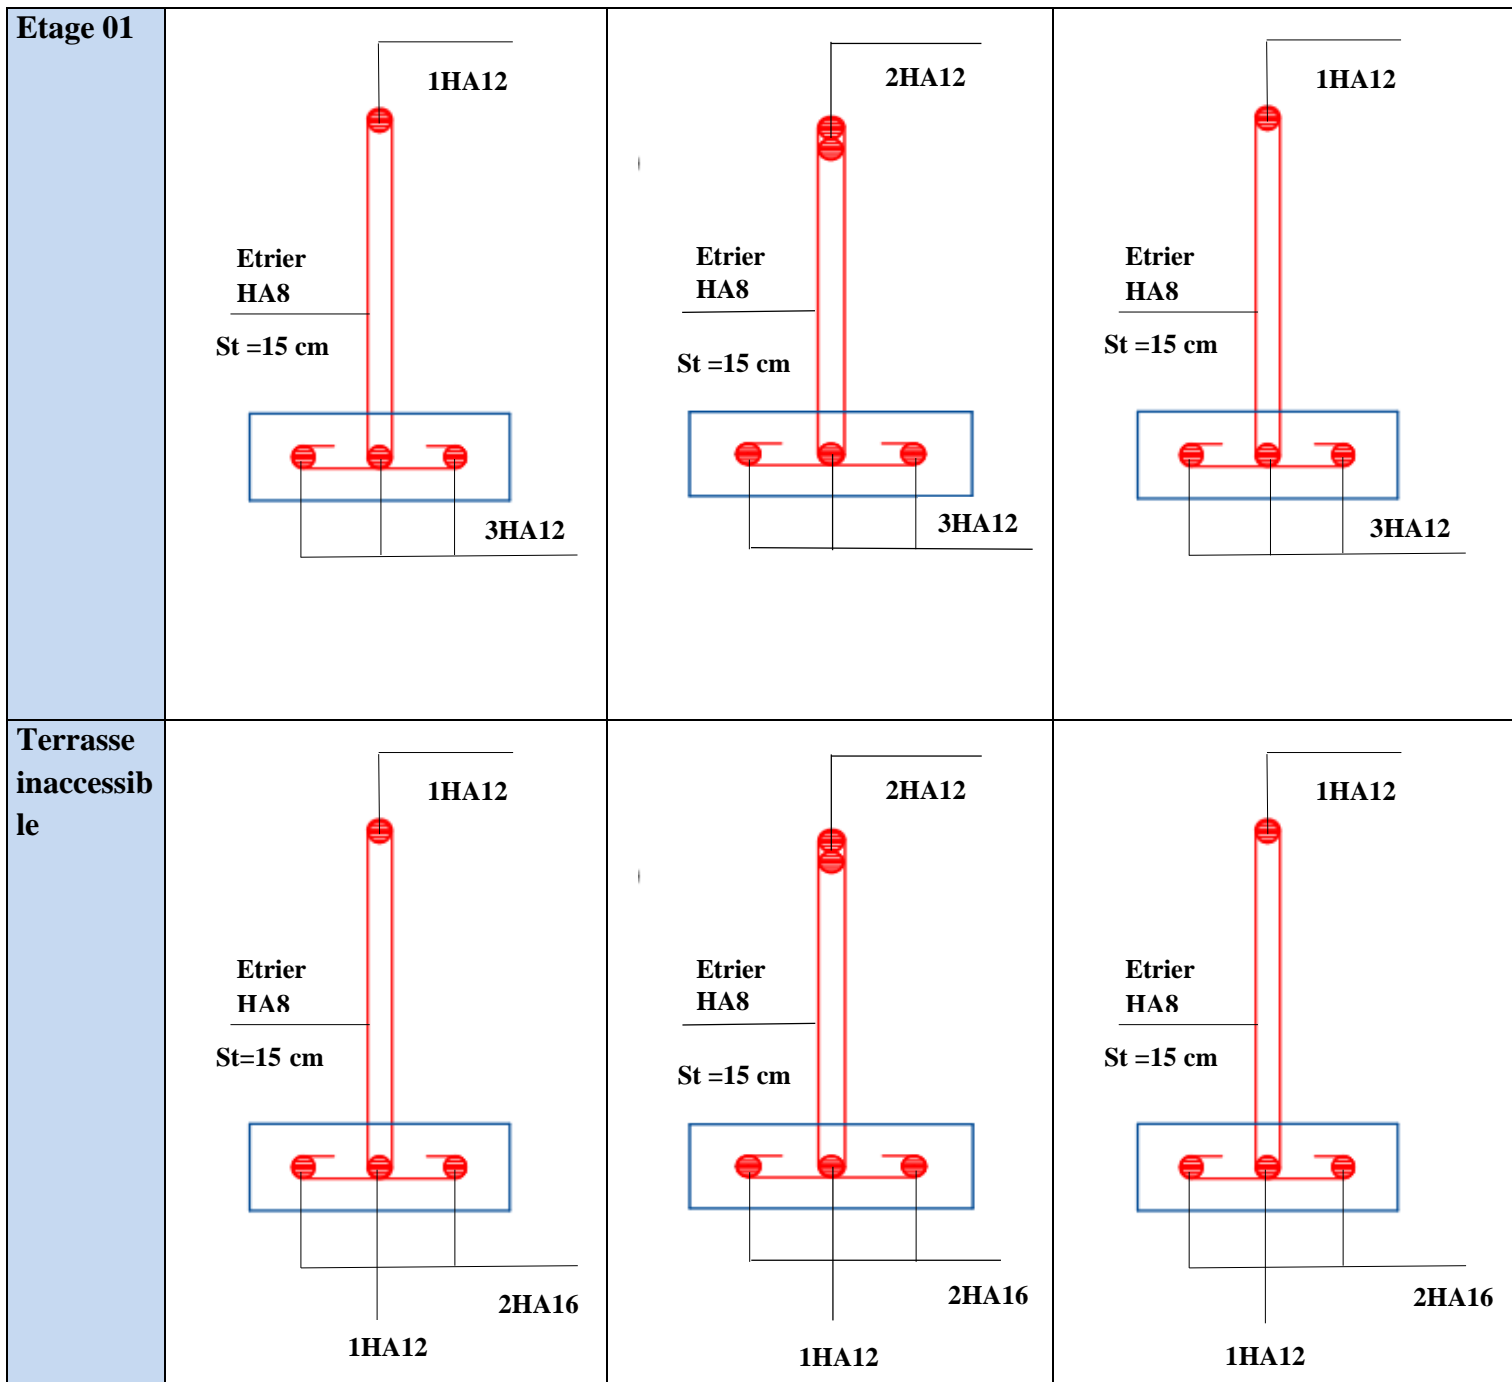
Schéma de ferrailage des poutrelles par niveau
